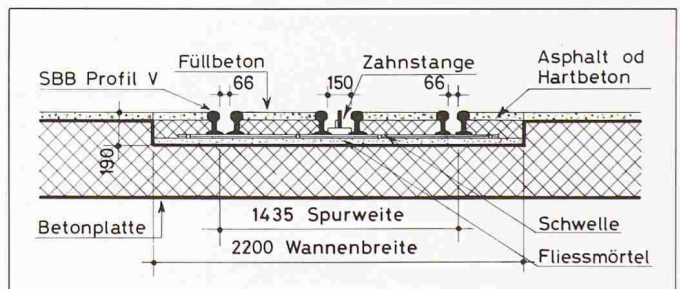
Zonen mit einbetoniertem Gleis, befahrbar
